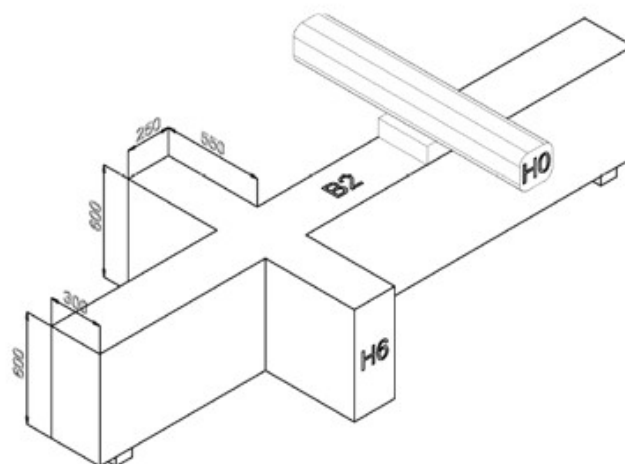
Descrição do corpo de prova B1 (dimensões em mm)
